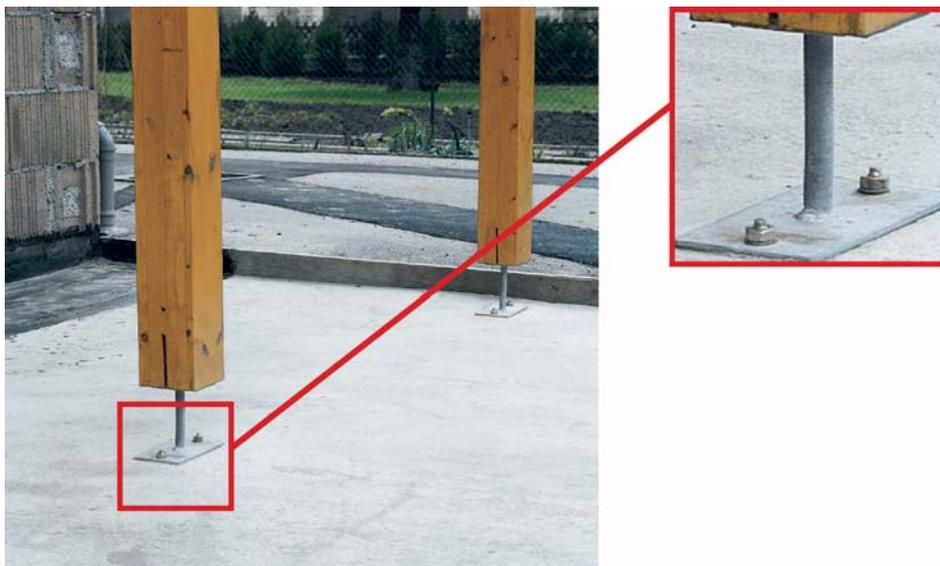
fissaggio del piede di un pilastro con l'ancorante Würth W-FAZ/A4, M10
